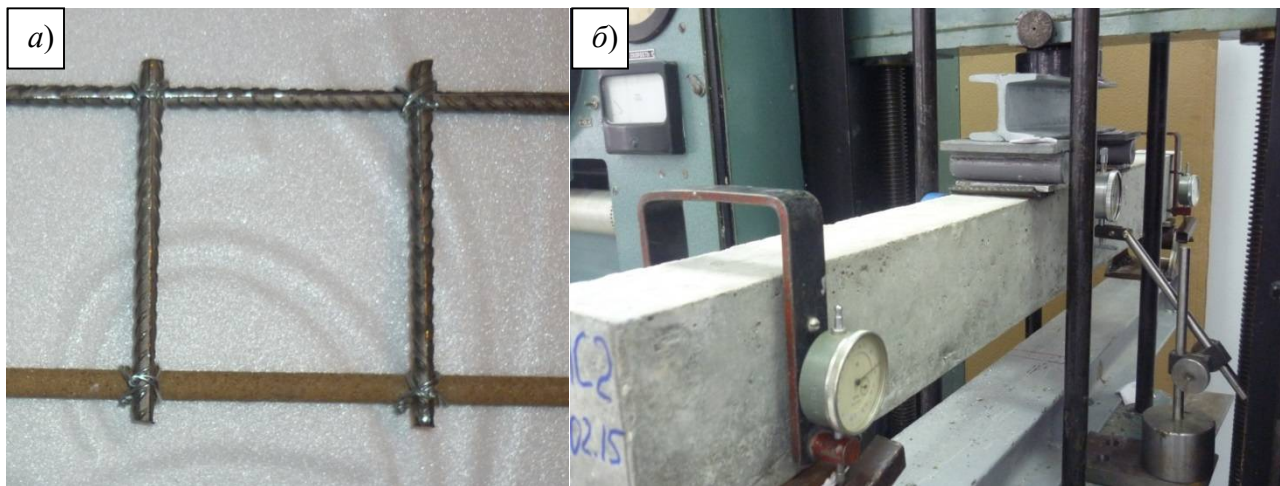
Соединения стержней арматуры вязальной проволокой (а) и общий вид образцов балок при испытаниях (б)
